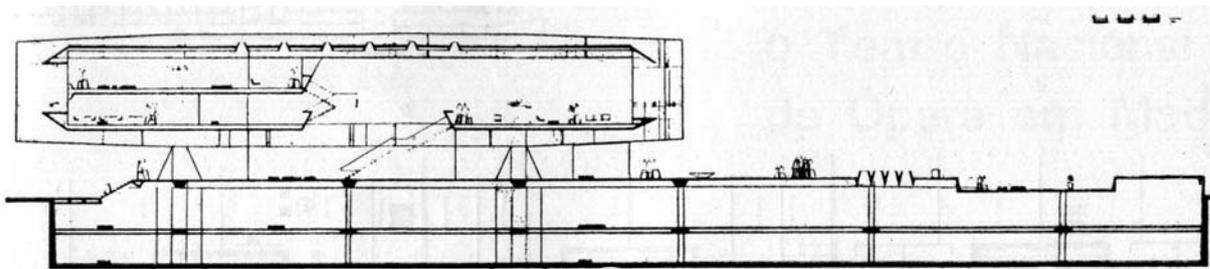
corte transversal A: subsolo: garagens e serviços; praça elevada; 1º nível do pavilhão elevado: hall do hotel.
